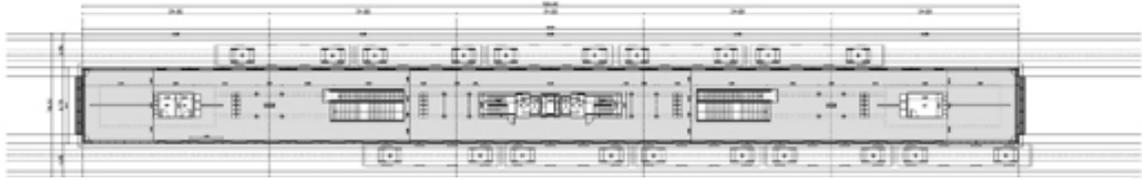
Estação oficial da Zona Franca Litoral, planta Piso 1
